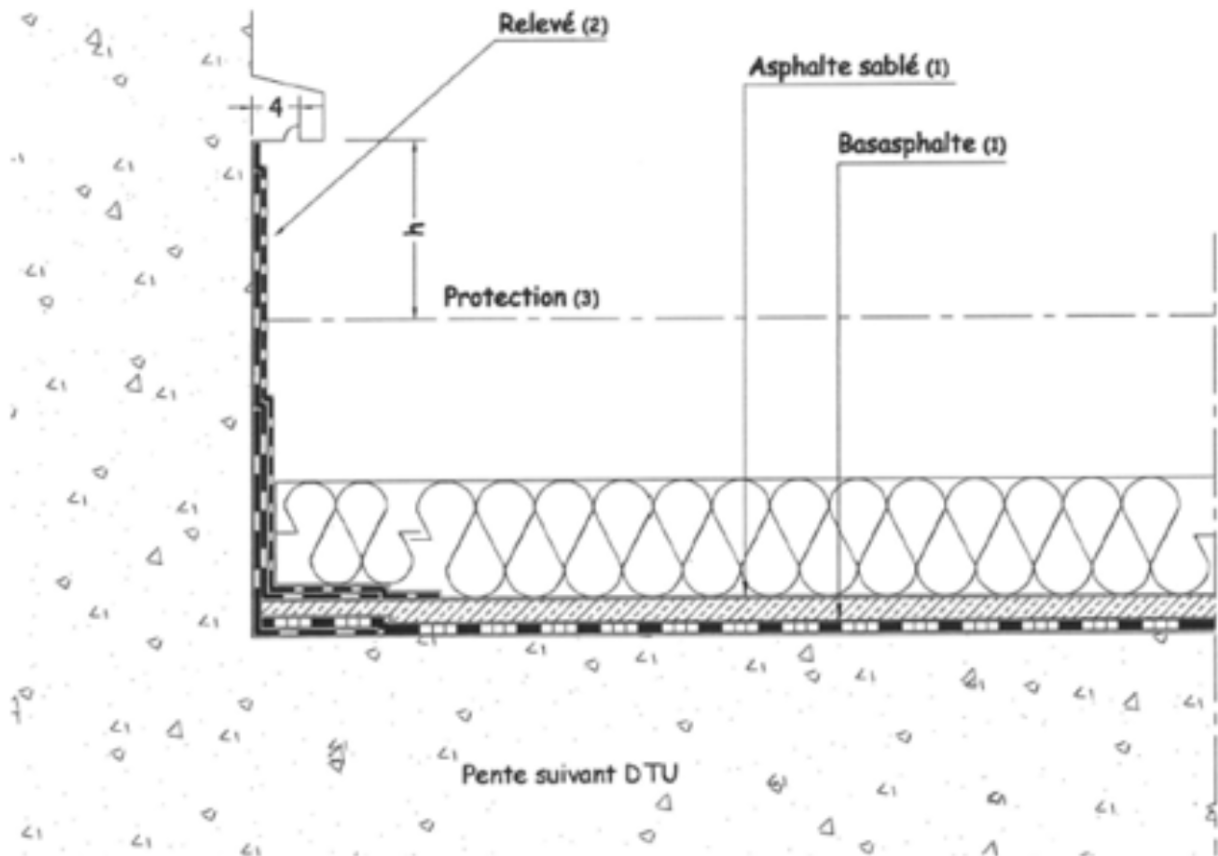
Coupe sur relevés en terrasse accessible aux piétons et protection par dalles sur plots, avec isolant support
